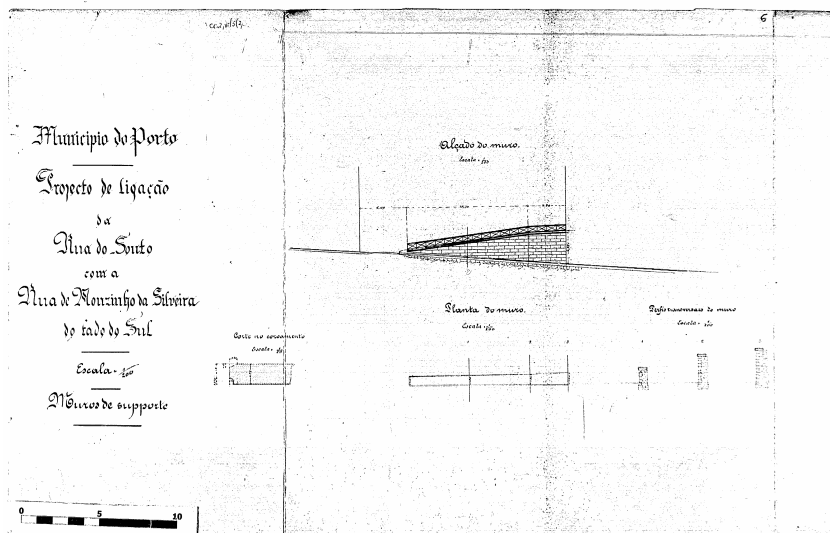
Projecto de ligação da Rua do Souto com a Rua Mouzinho da Silveira do lado sul - Muros de suporte (A.H.M.P. D-CMP-02-20-006)
